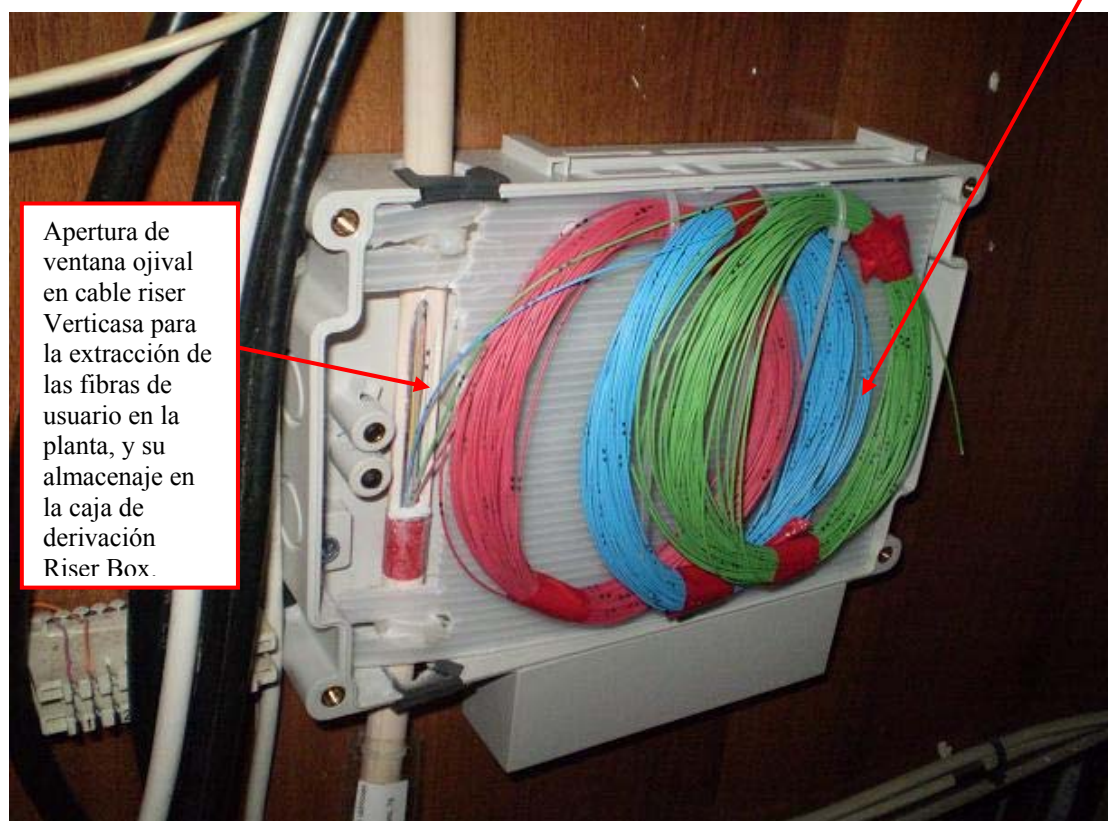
Vista exterior de caja Riser Box Verticasa, de derivación de planta 5ª
